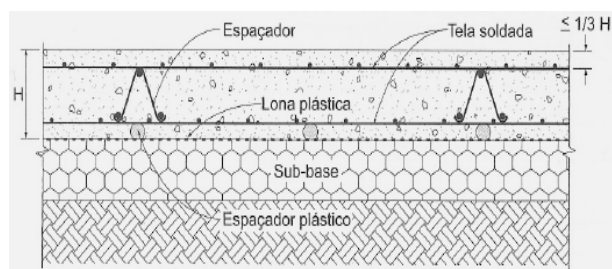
Pavimento de betão estruturalmente armado, [22].
